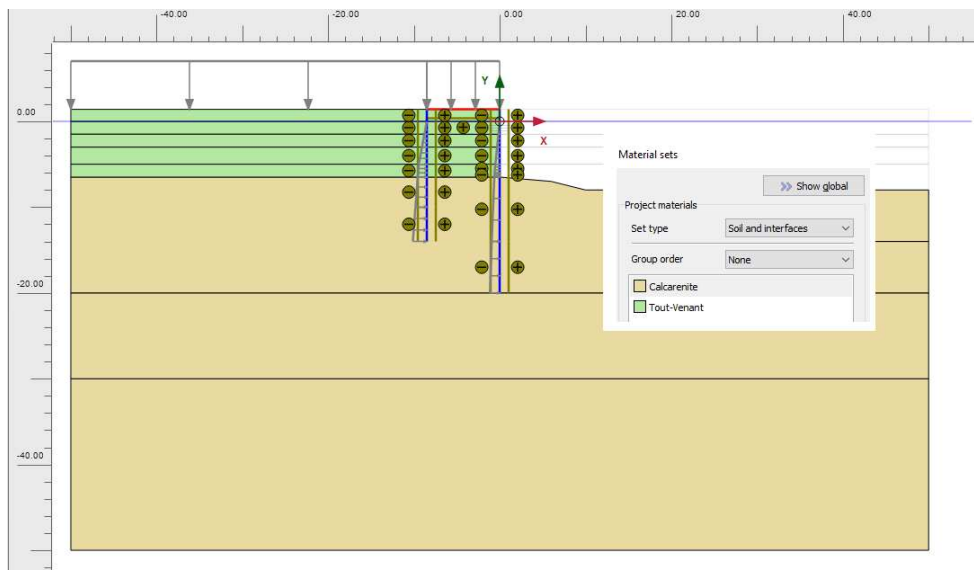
Sezione 2 – Modello geotecnico di calcolo
